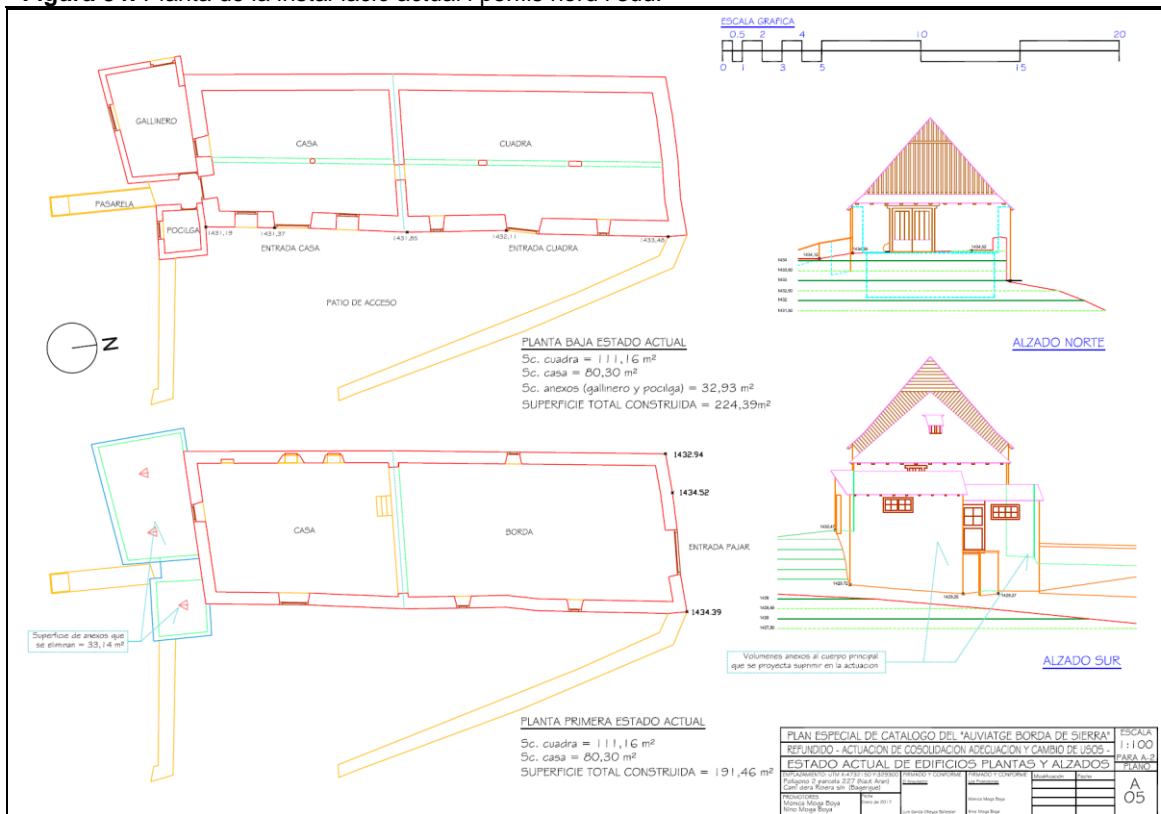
Planta de la instal·lació actual i perfils nord i sud.
